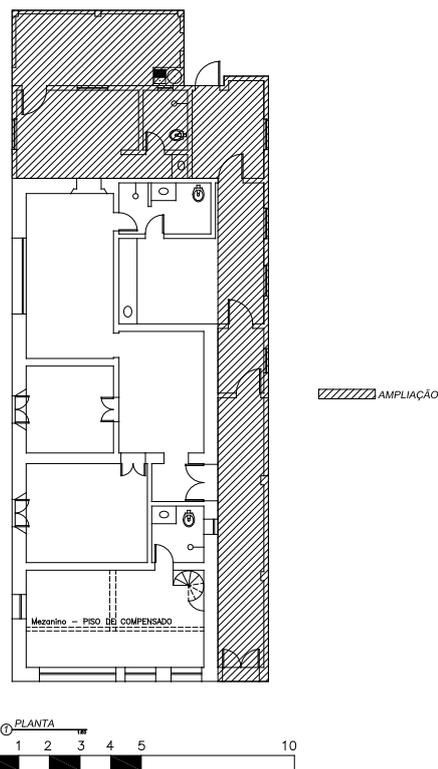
Planta Casa João Tomé Siqueira - modificações ao projeto original em hachura
